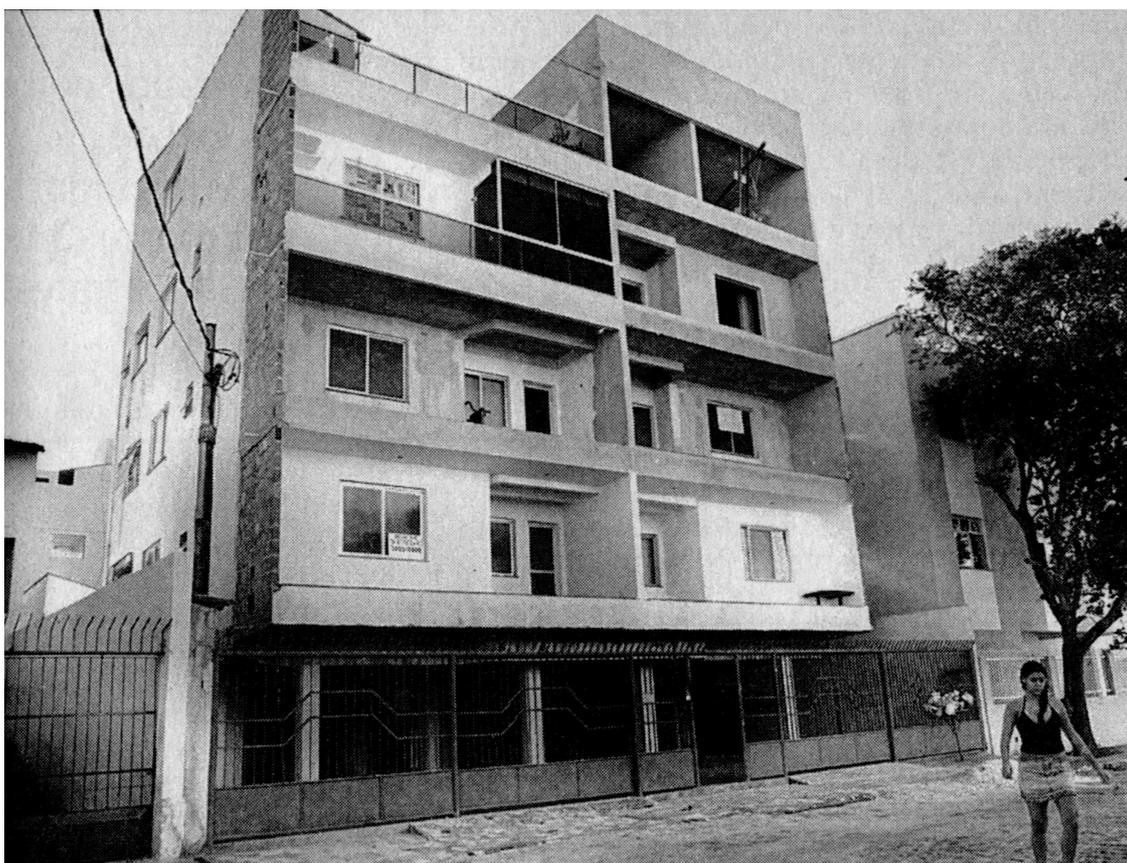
edificação com grave patologia estrutural. Observar a trinca no sentido longitudinal do pilar.
